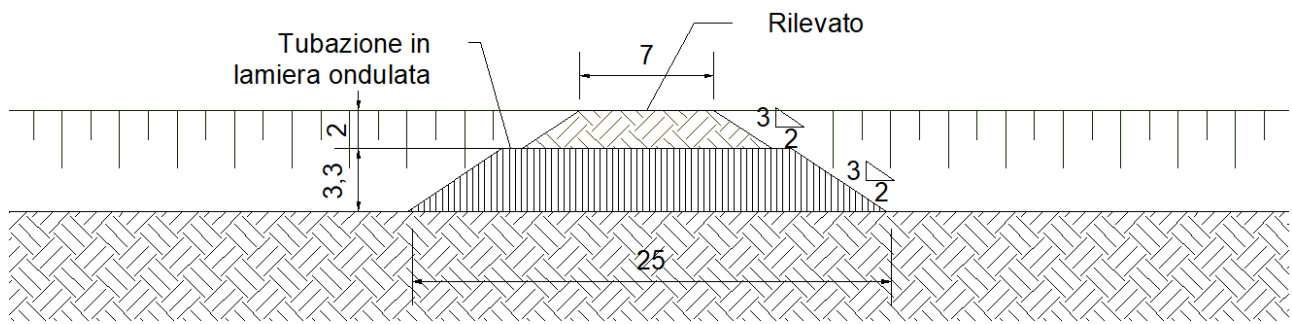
Profilo longitudinale dell'attraversamento provvisorio
